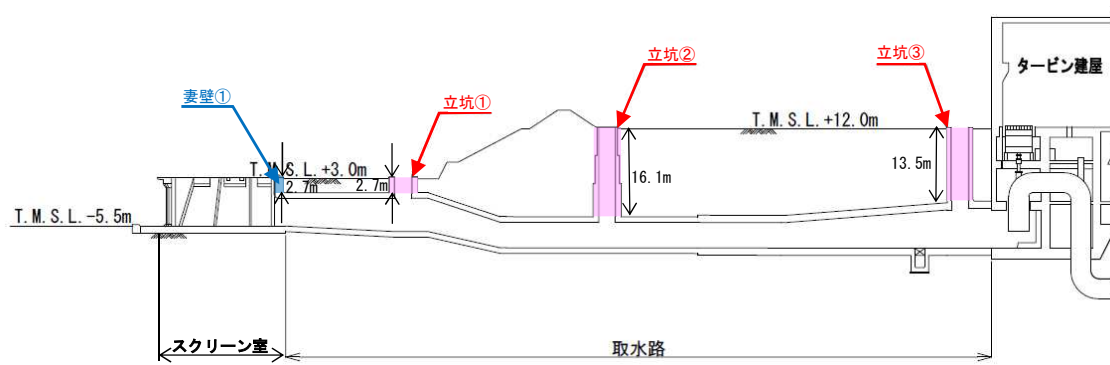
7号炉スクリーン室，取水路縦断面図
